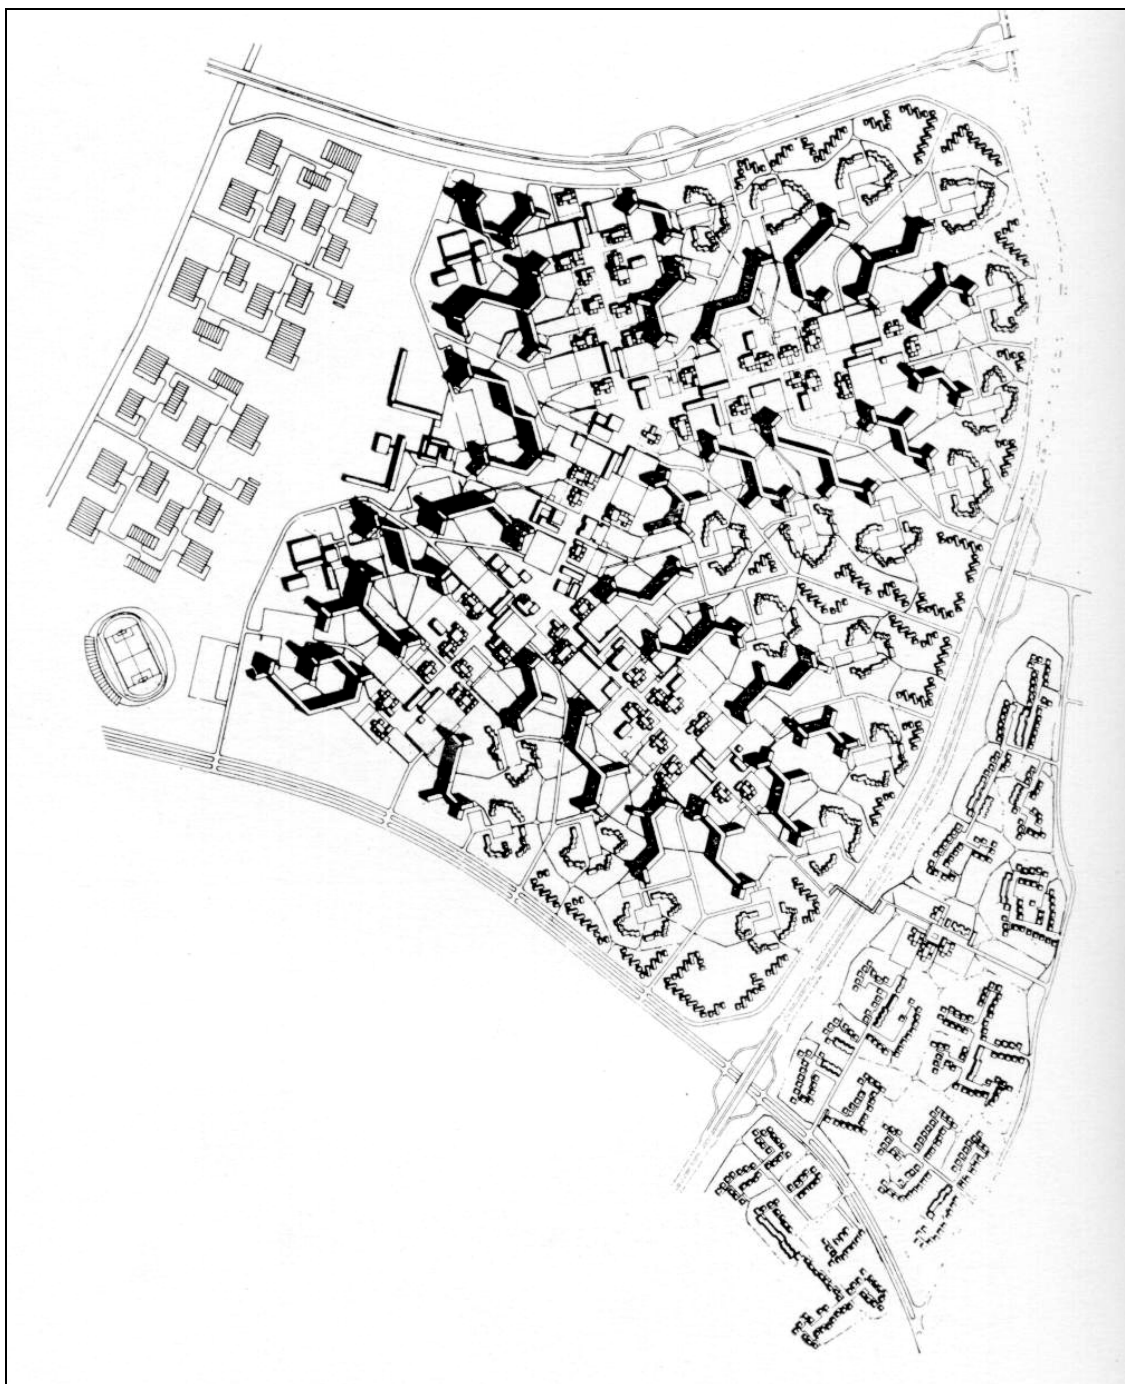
Articulação dos domínios público e privado. Concurso Caen-Hérouville de 1961, centro linear – planta geral.
